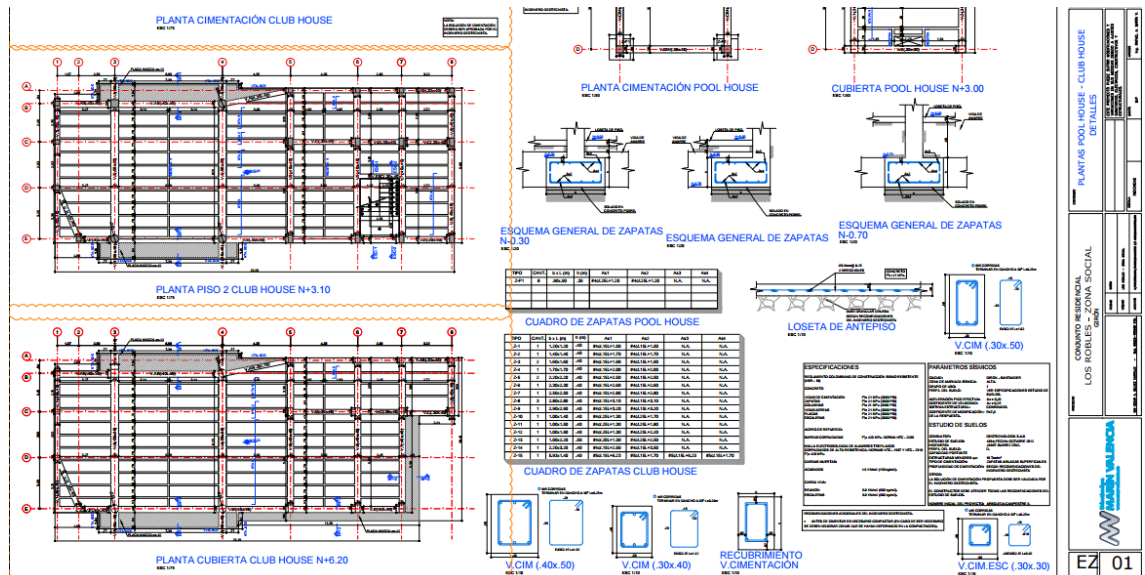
Planos usados para el cálculo de cantidades de acero y concreto para Club House.
